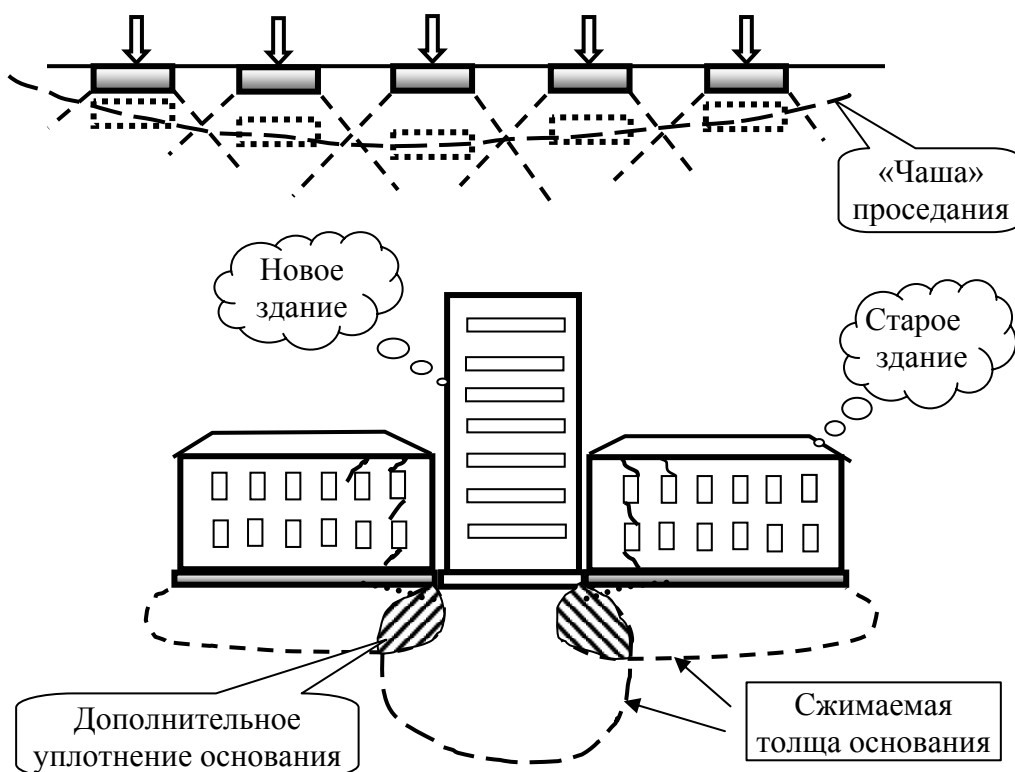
Неравномерные осадки уплотнения при влиянии нагружения соседних фундаментов
